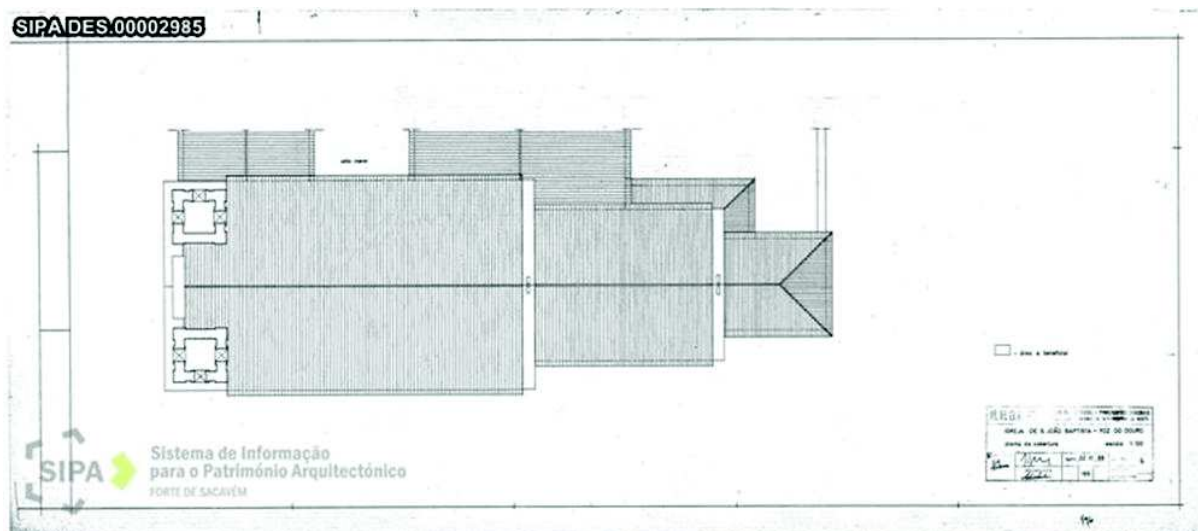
Planta do telhado em duas águas da Igreja Paroquial de São João Batista da Foz do Douro.
